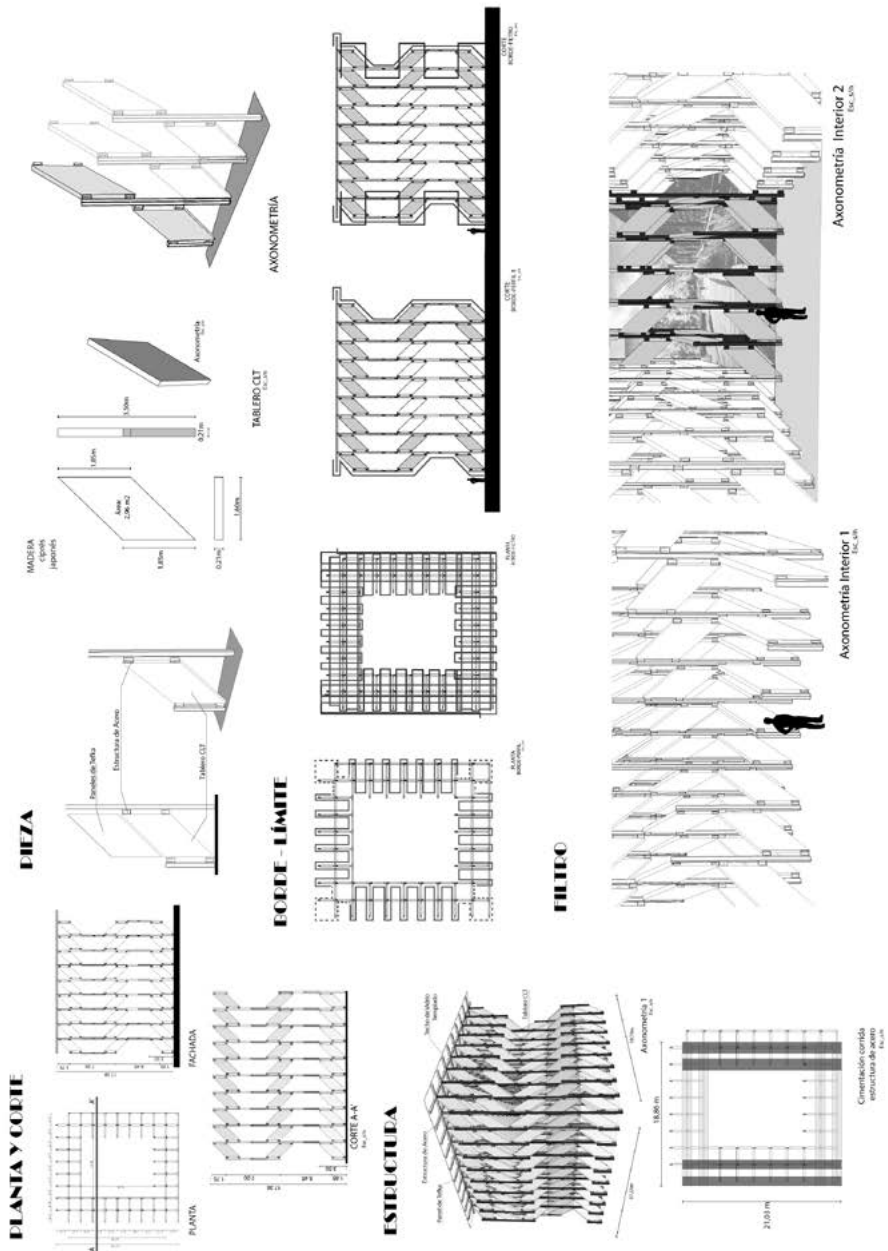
Planos, Estructura, Pieza, Borde – límite, filtro CLT Park. Fuente: Elaboración propia.
